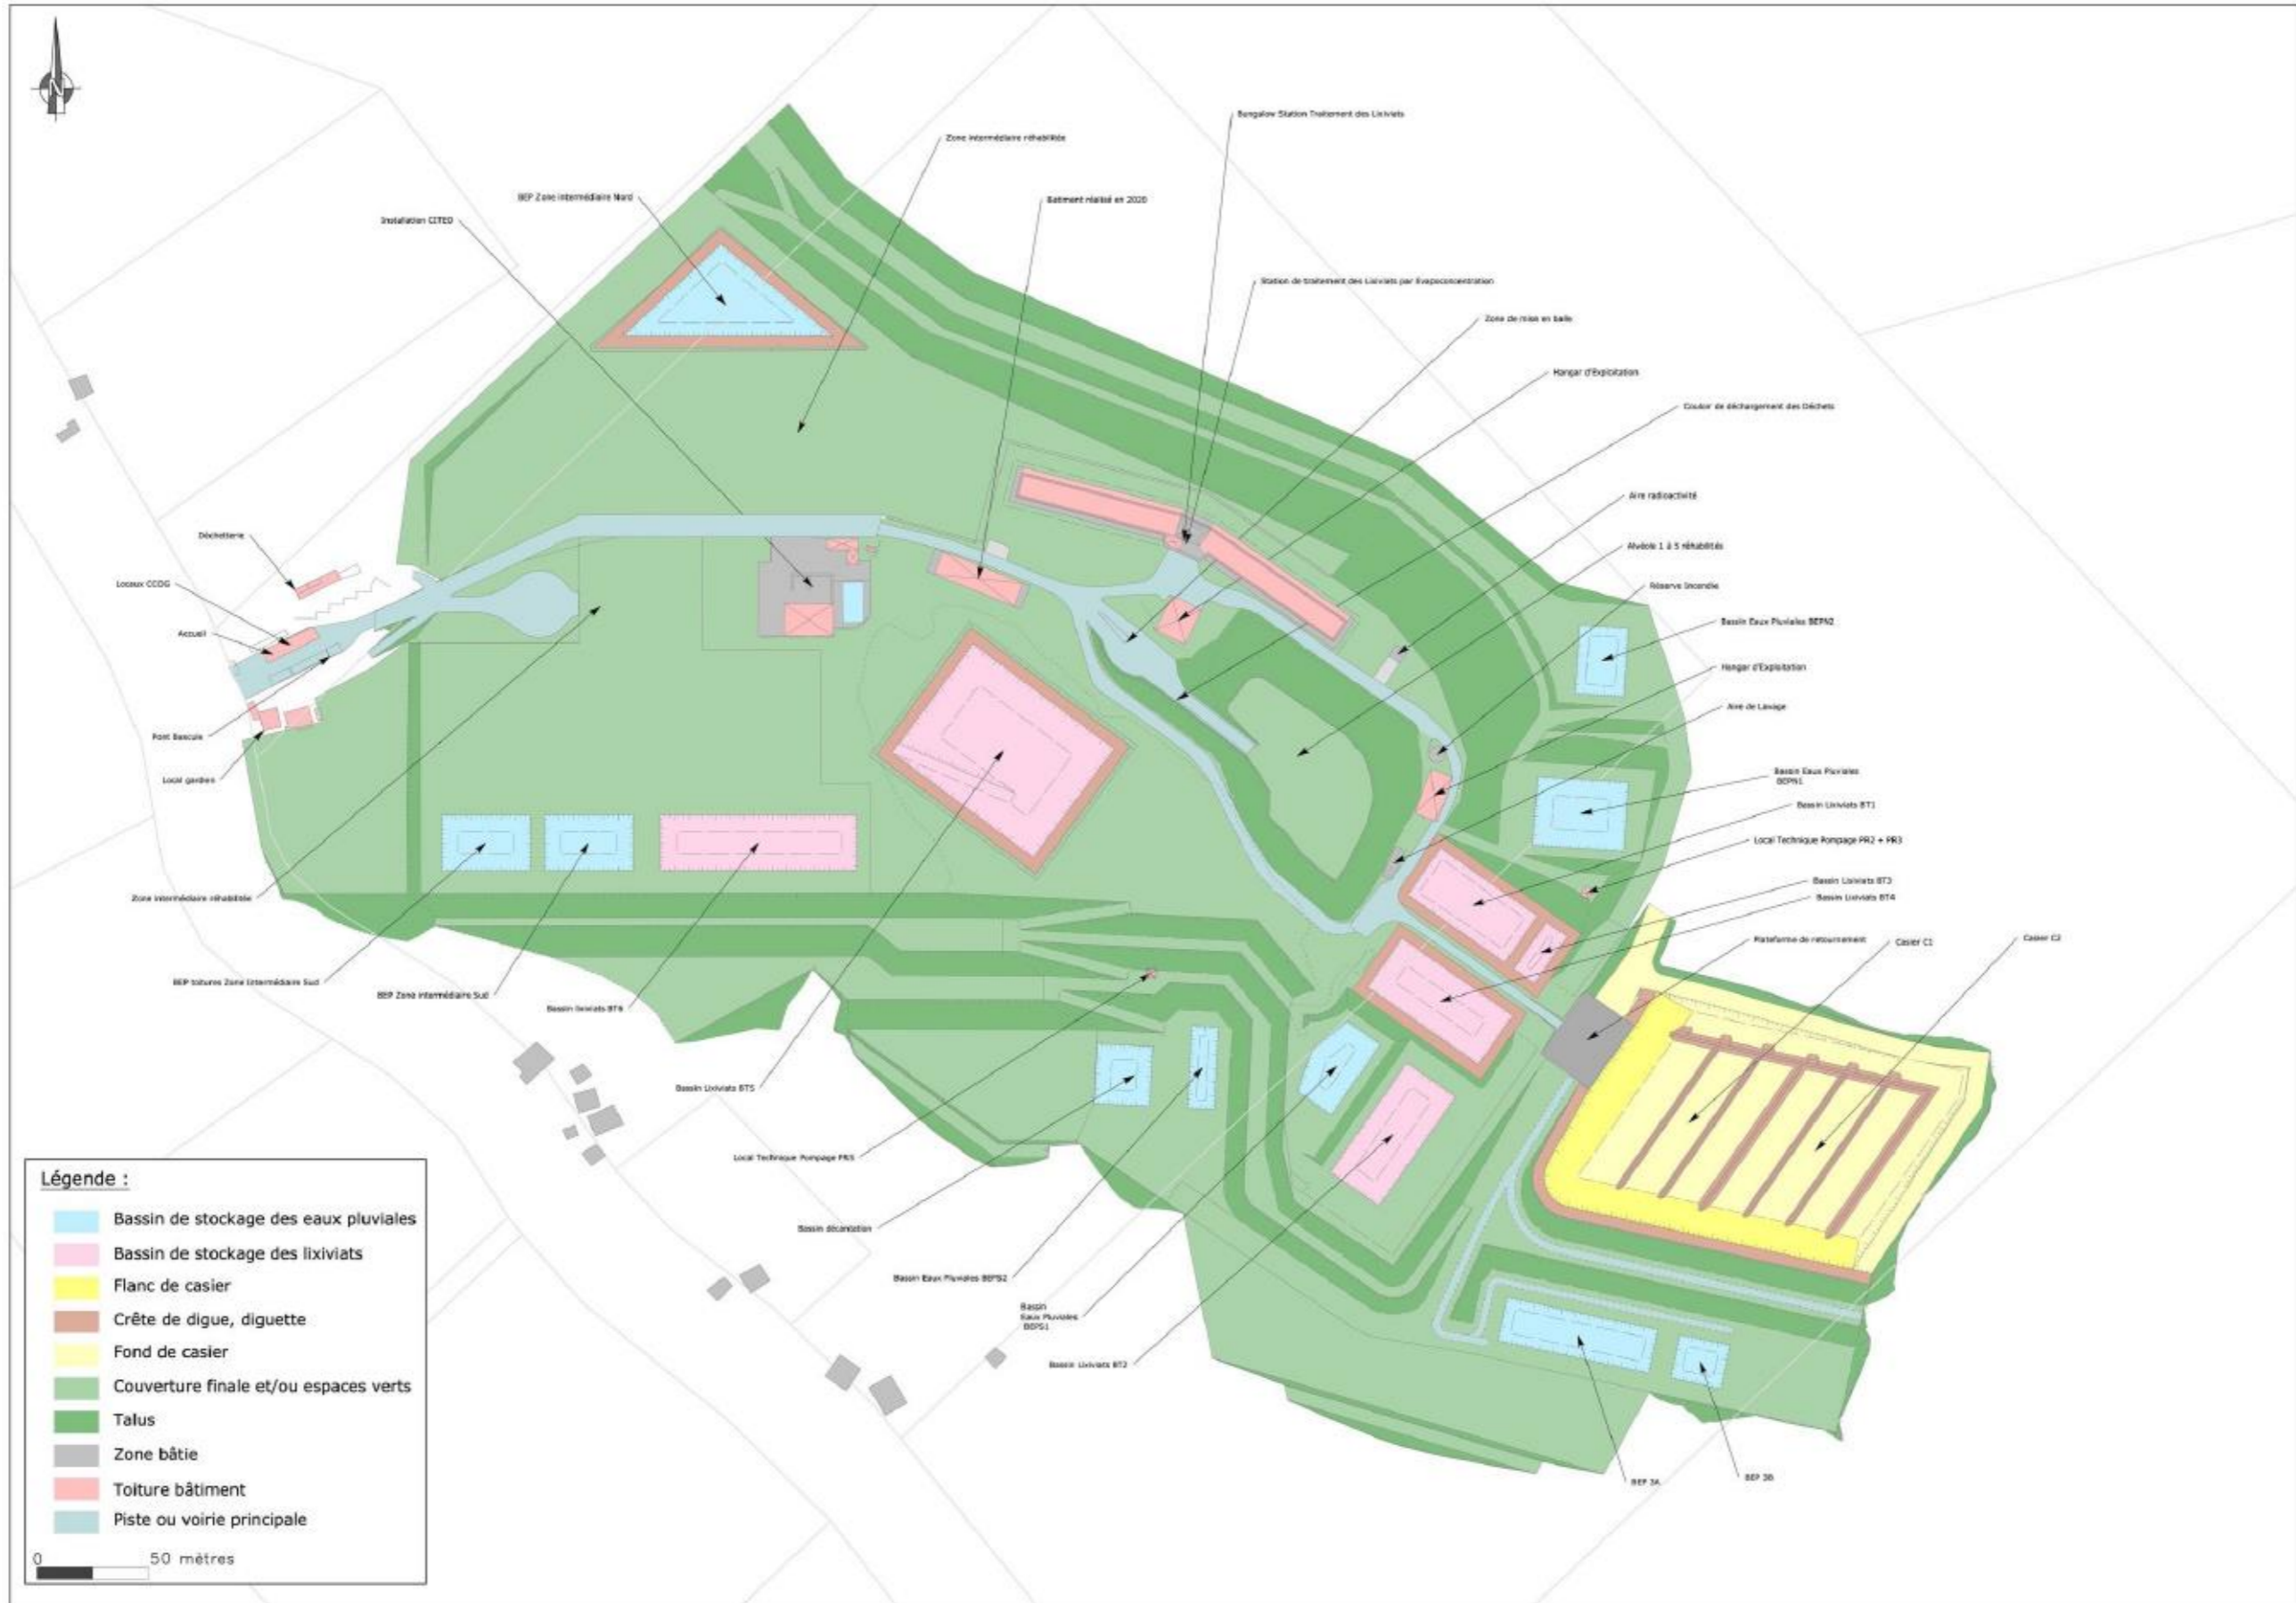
Plan général des installations existantes (Source BETA Environnement)
